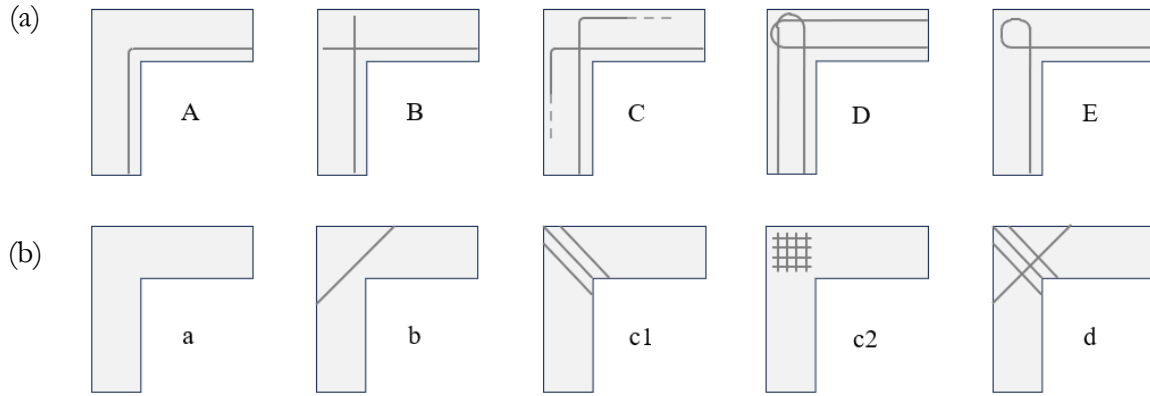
Detalles de armado: (a) armado de flexión; (b) armado secundario.
